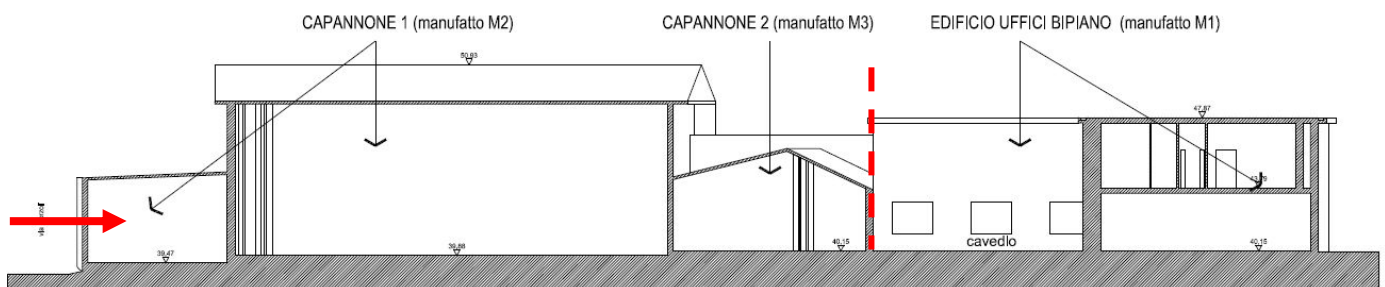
Sezione longitudinale cantiere in fase 1 (edifici M2 e M3)
